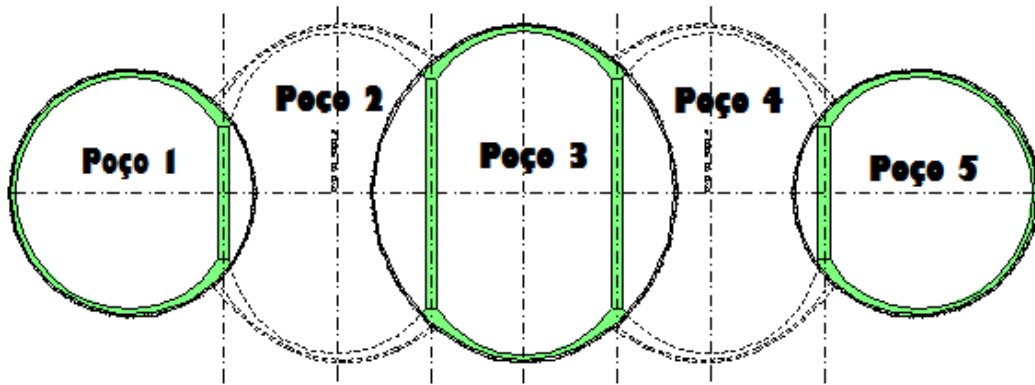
Planta com execução das vigas de travamento e revestimento secundário nos poços 1, 3 e 5 (Adaptado CJC, 2008).
